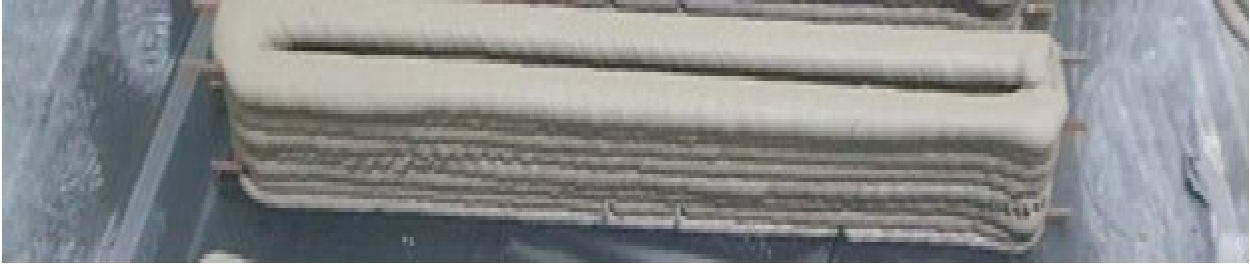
Балка, надрукована методом 3D друку із можливістю вертикального армування.
